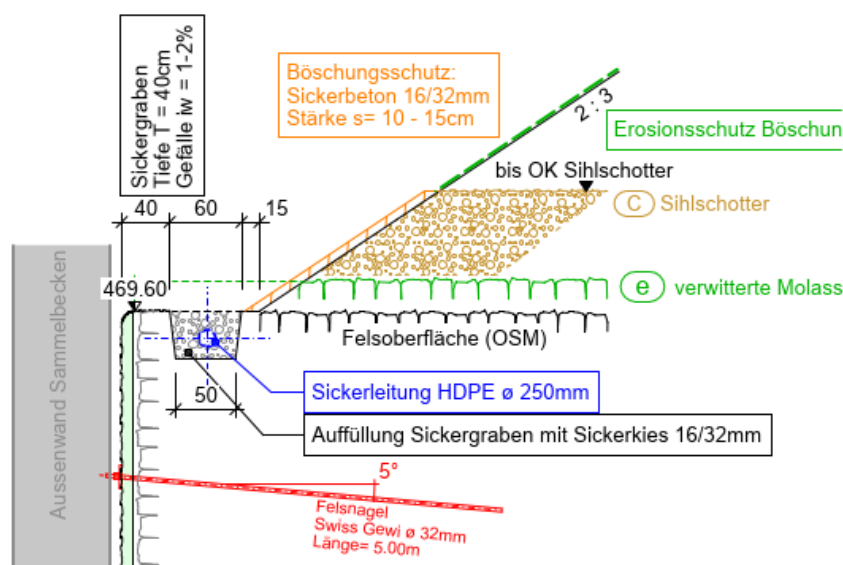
Systemschnitt Wasserhaltung Böschung Ostseite
